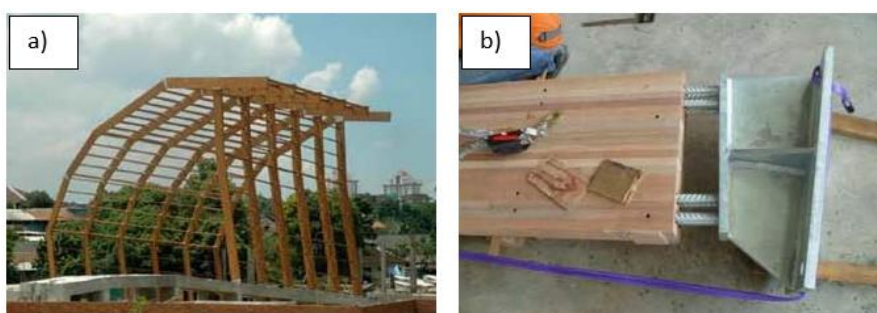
Estrutura do *MTIB building* (Malásia) a). Pormenor de ligação com GiRs b).
